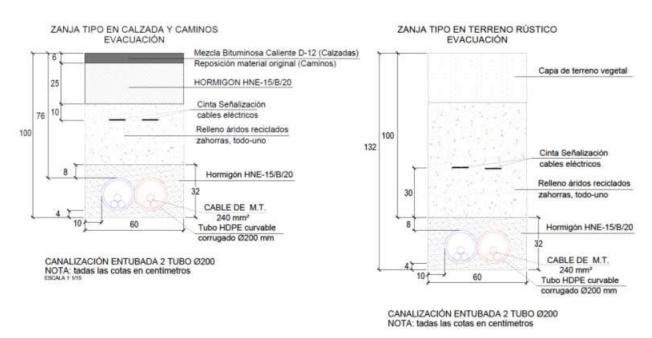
Detalle secciones tipo. Fuente: Proyecto de ejecución.
